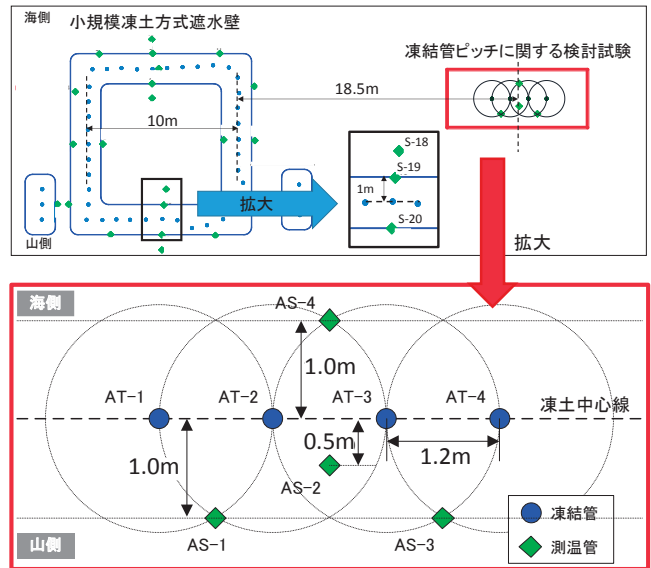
追加試験平面配置図 (Layout of Additional Test)
